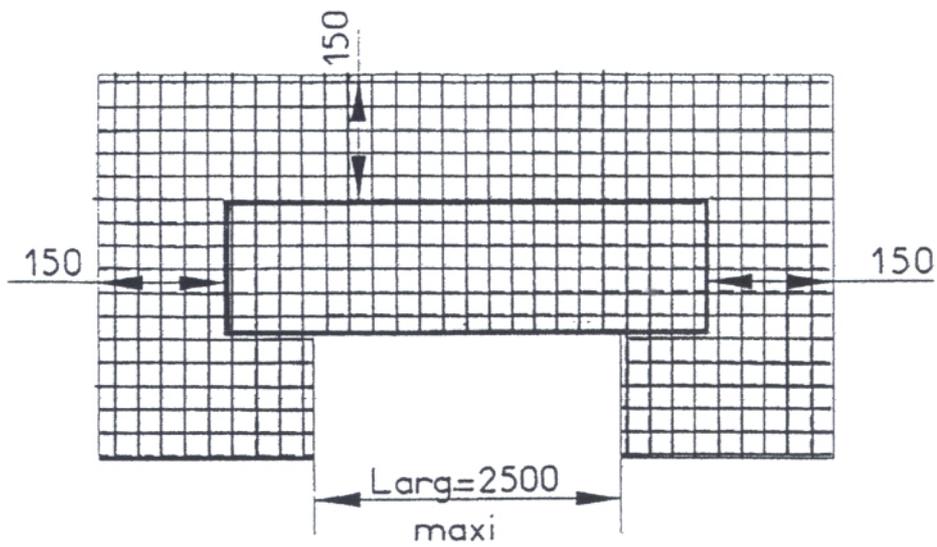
renforcement des enduits pour des largeurs de baies inférieures ou égales à 2,5 m.
